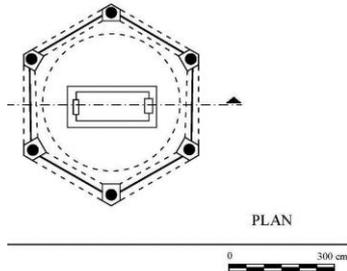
مسقط أفقي لترتبة دار الحديث في أدرنة عن:
